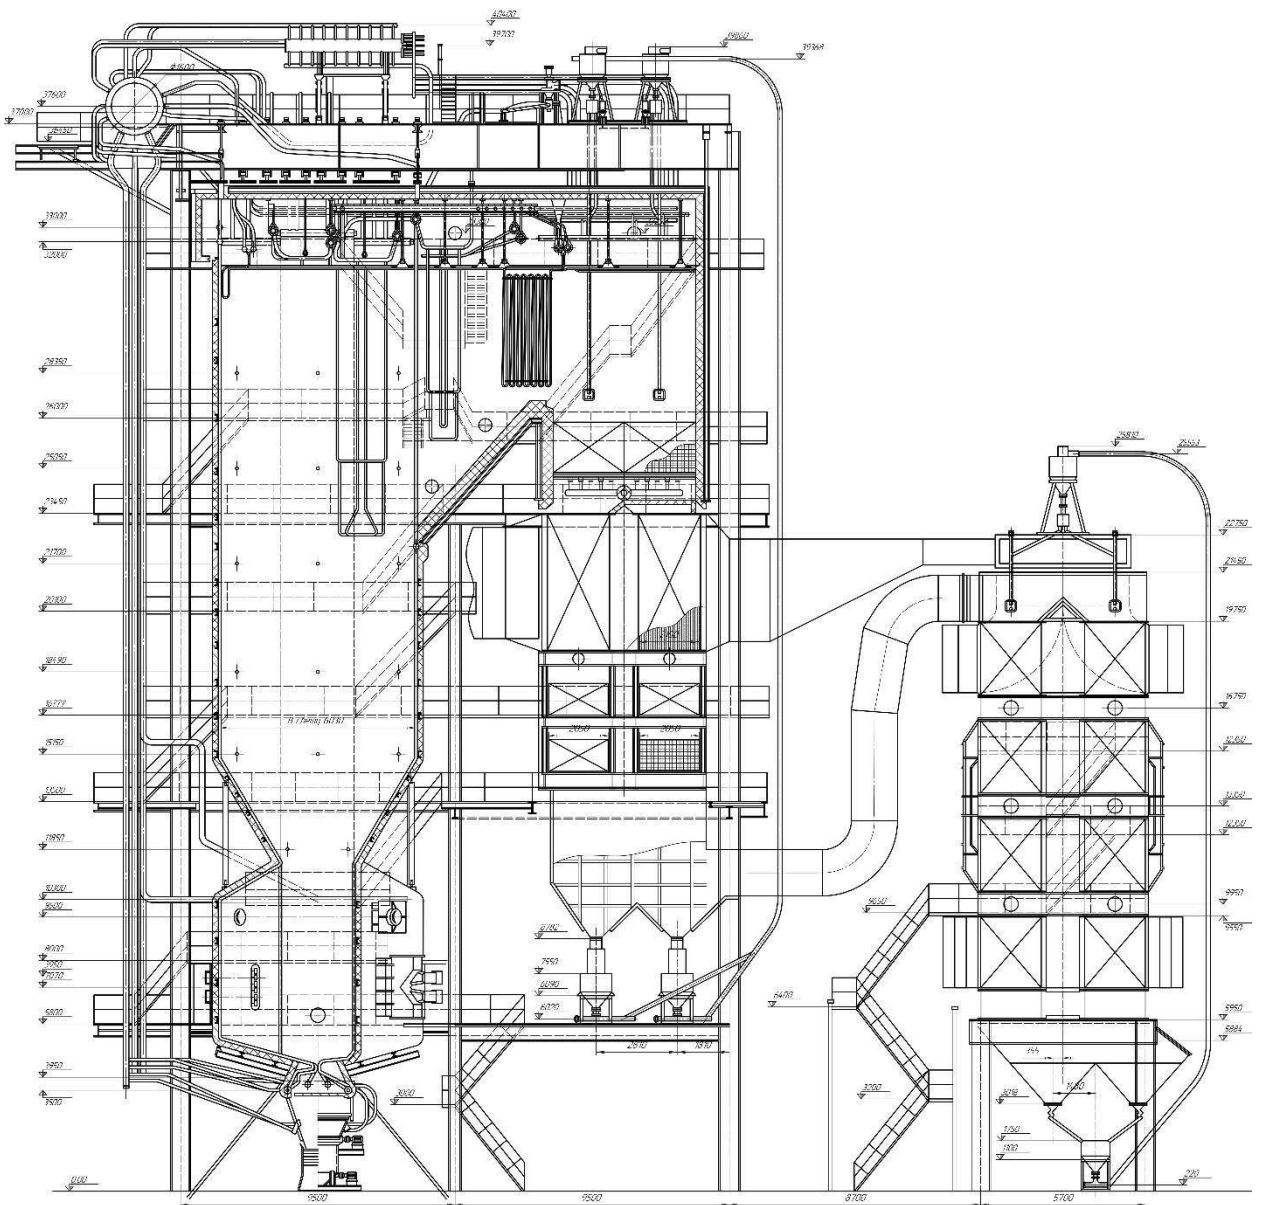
Продольный разрез котлоагрегата БКЗ-420-140ПТ1
